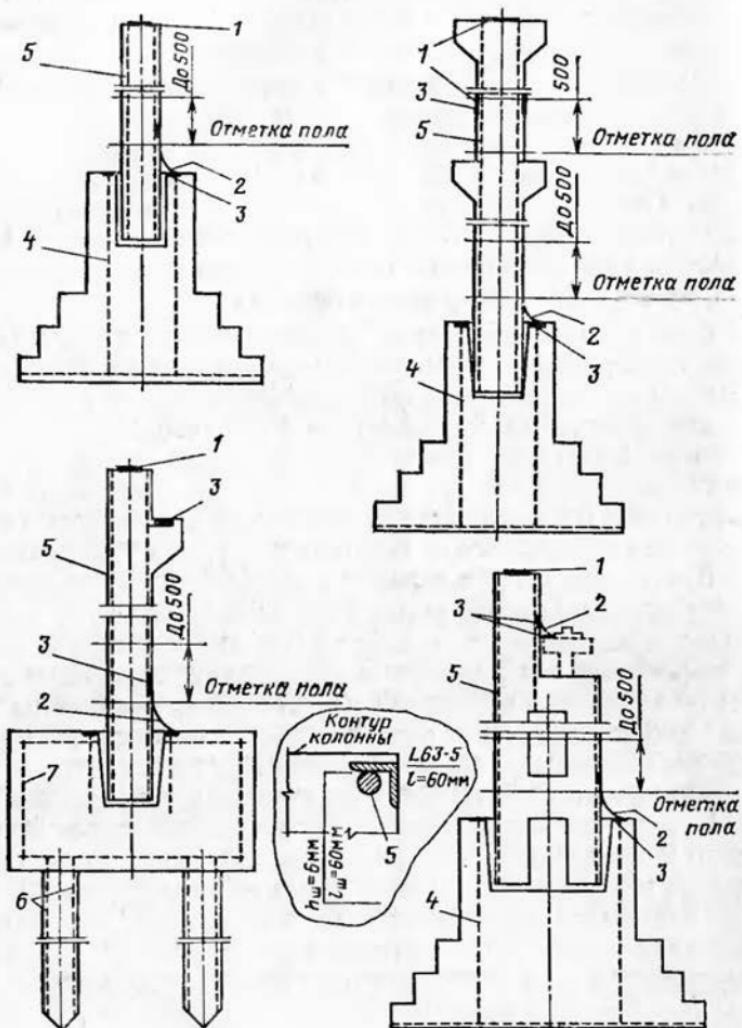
Соединение железобетонных фундаментов с железобетонными колоннами:
